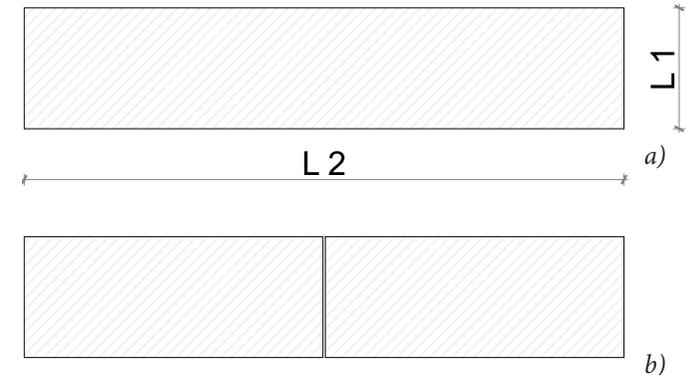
a) Relación de longitud en planta L1 - L2
